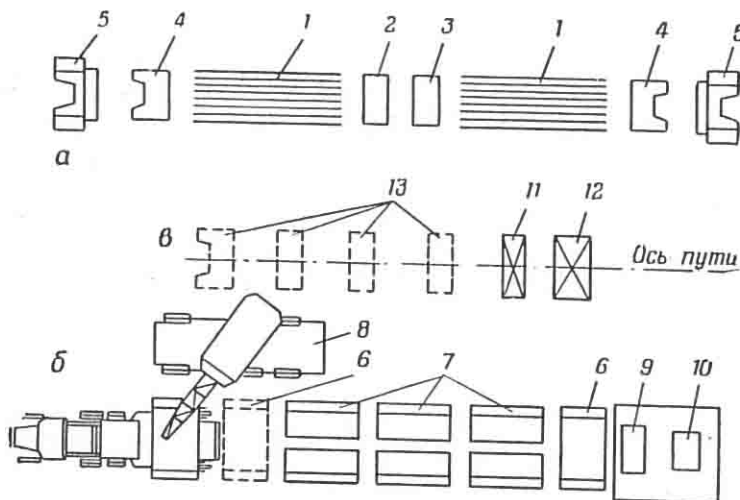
Примерная схема строительной площадки при сооружении свайно-эстакадного моста:
